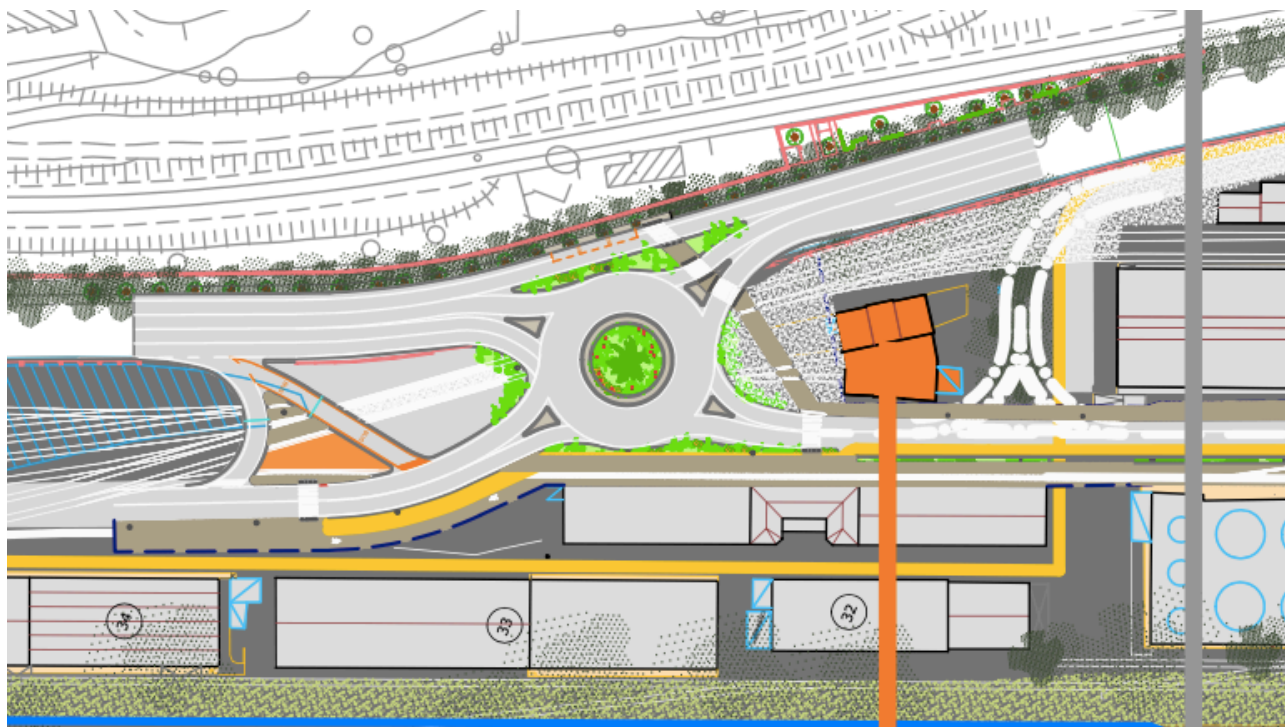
Assetto di progetto dell'Accesso Nord (fonte Masterplan Porto Vecchio - Comune di Trieste)
